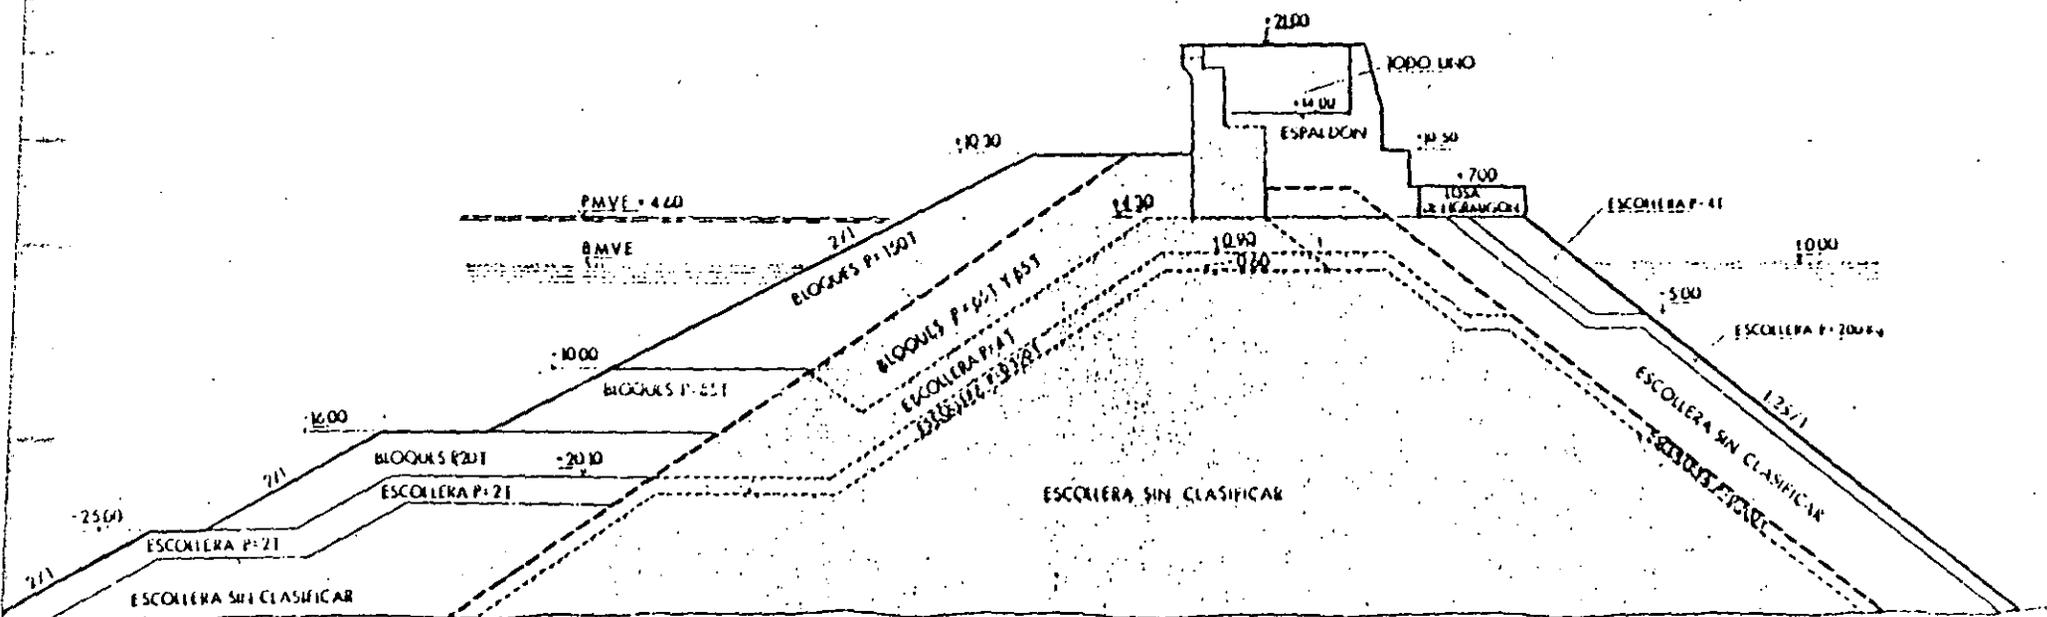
SECCION TRANSVERSAL DEL DIQUE DE PUNTA LUCERO EN BILBAO Y DE SU REFUERZO
